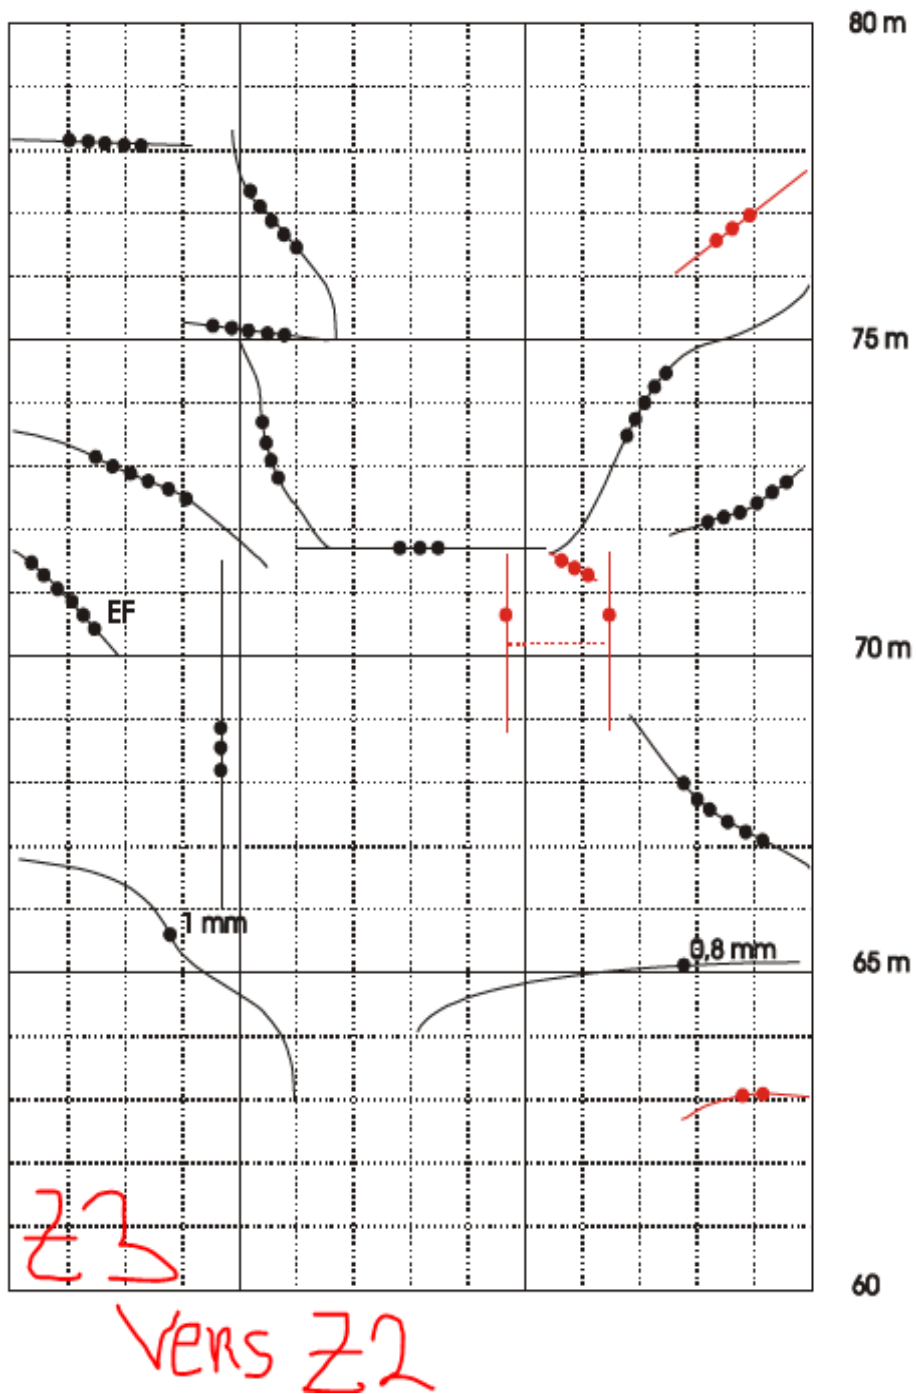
Planche de fissuration travée Nord-Est Zone 3
